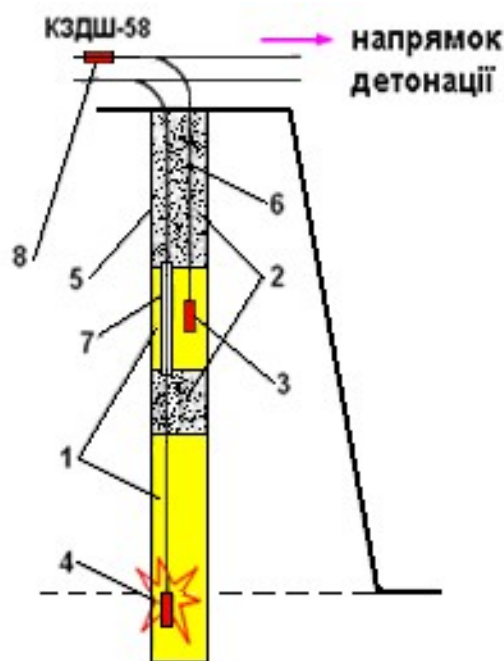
Конструкція свердловинного заряду ВР (схема уповільнення «знизу»): 1 – вибухова речовина; 2 – набивка; 3 і 4 – відповідно, верхній і нижній проміжний детонатор; 5 – свердловина; 6 – ДШ; 7 – трубка-ізолятор; 8 – піротехнічне реле
